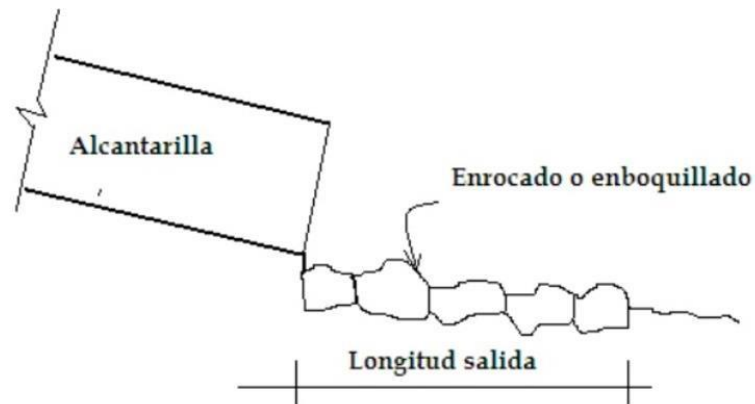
Protección de enrocado a la salida de una alcantarilla.
